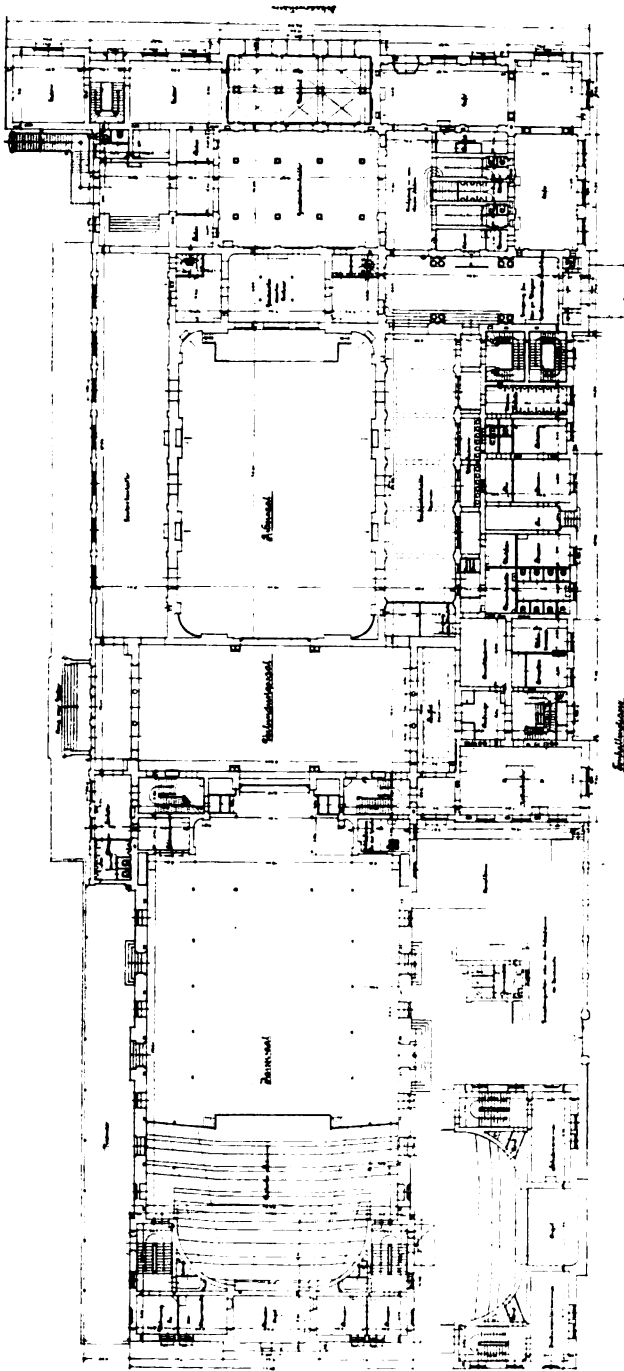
Erdgeschoss der Tonhalle. 1:735.
